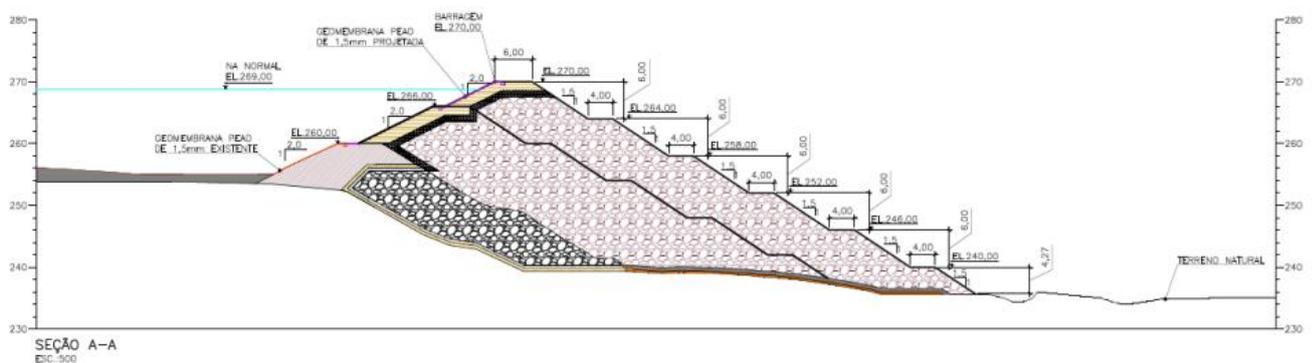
Seção alteamento maciço principal da barragem de Lixiviação – configuração final para o alteamento na El. 270,00 m.
